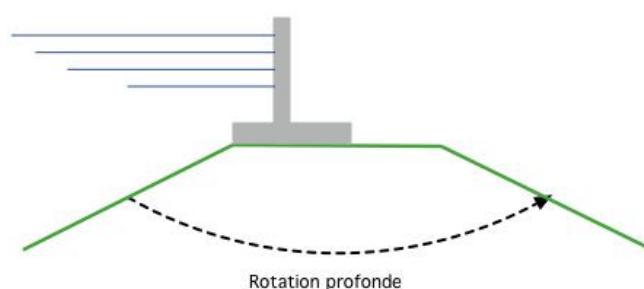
Instabilité profonde sur une digue en remblai rehaussée par muret (NB : la digue était stable avant rehausse) (Schéma : Rémy Tourment)
